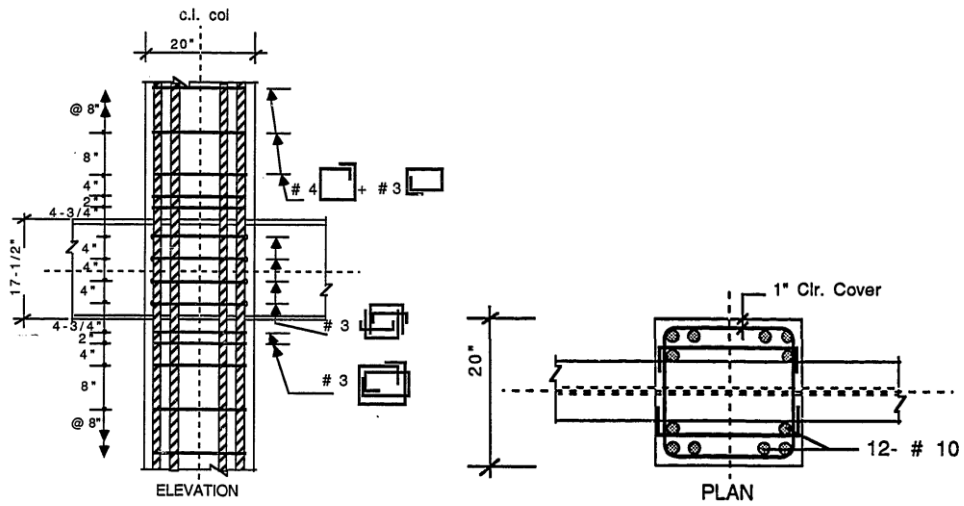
Detalles del refuerzo en la junta para las pruebas 3 hasta 7 y 9, en vista de corte y vista de planta. Nota. Shikh muhammad t. moment connections between steel beams and concrete columns (1987) (pág.52)
